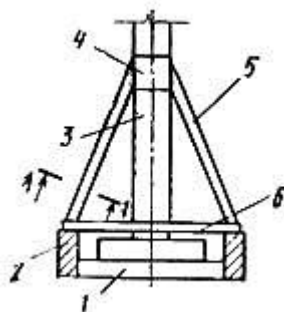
Усиление фундаментов подводкой: 1 – усиливаемый фундамент; 2 – дополнительные фундаменты; 3 – колонна; 4 – металлическая обойма; 5 – металлические подкосы; 6 – элемент усиления
